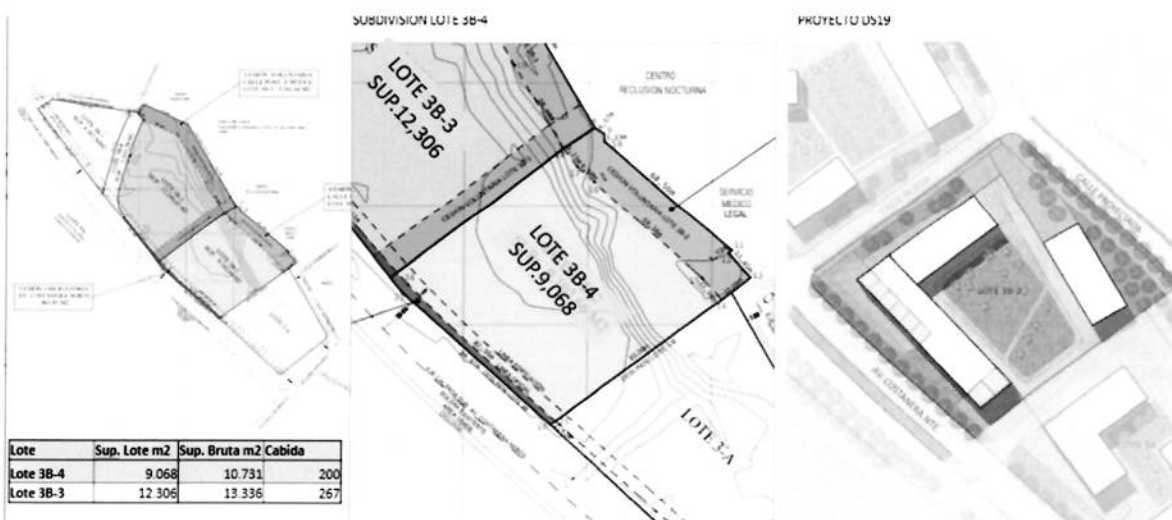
Coherencia Plan Maestro Kaukari, Lote 3B-4 Proyecto DS.19
